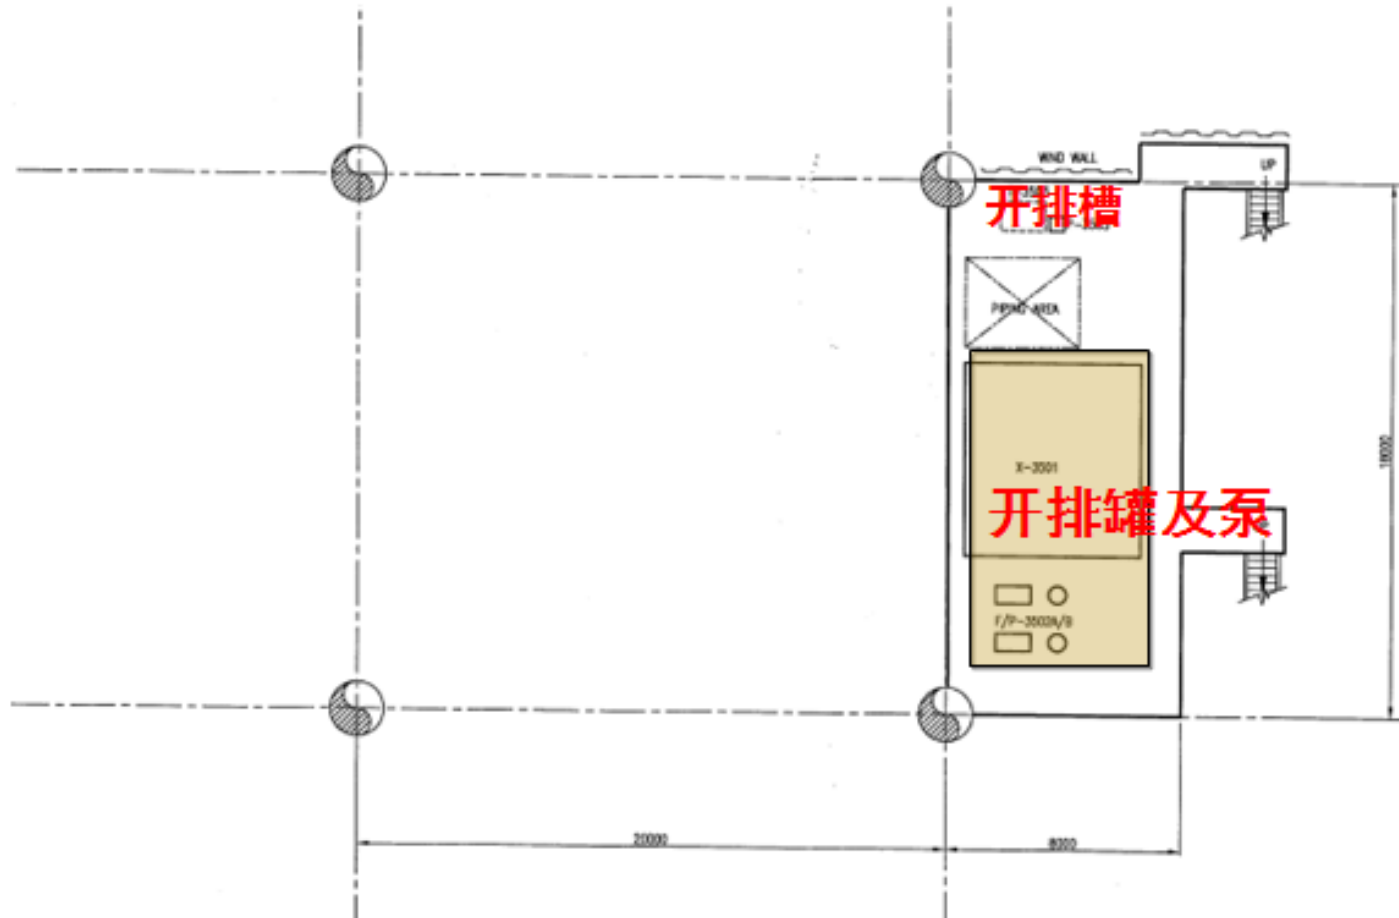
QHD32-6CEPK 工作甲板平面布置图
